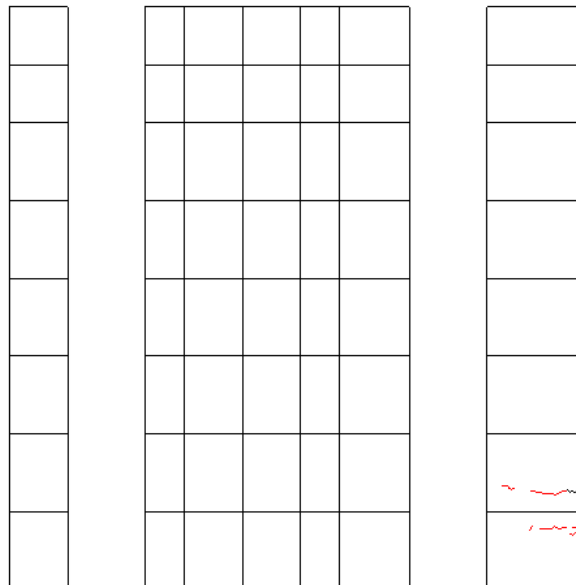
R=-1/1600 ひび割れ図
